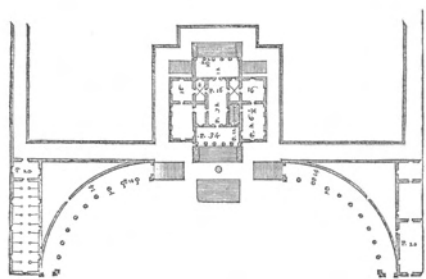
Planta baixa Villa Badoer - Fonte: Palladio, 1570.
